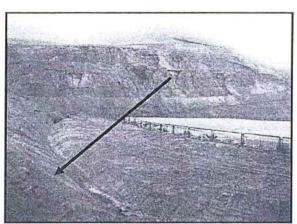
Construcción de las cunetas de coronación de la Poza 18.
